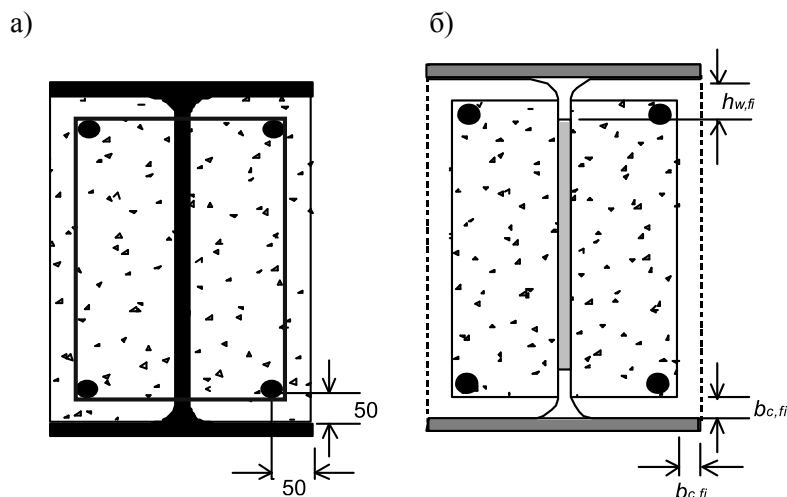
Расчетное сечение сталежелезобетонной колонны при нормальной температуре (а) и в условиях пожара (б)
